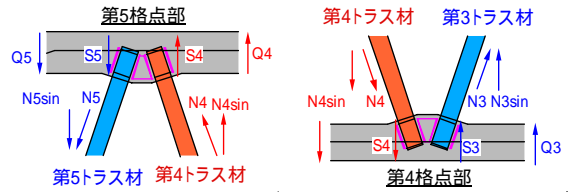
格点部周りの作用断面力 Acting Section Force of Joint
